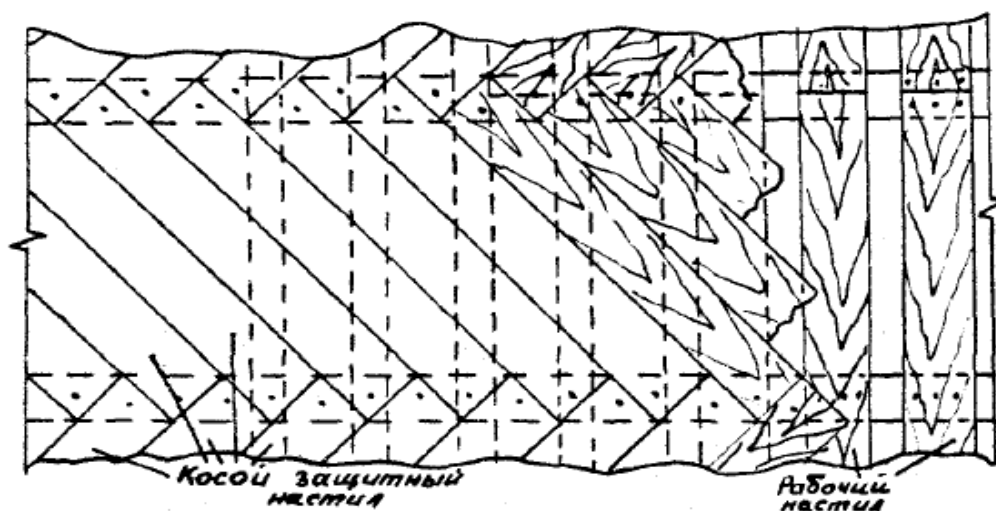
Конструкция двухслойного настила под рулонную кровлю
